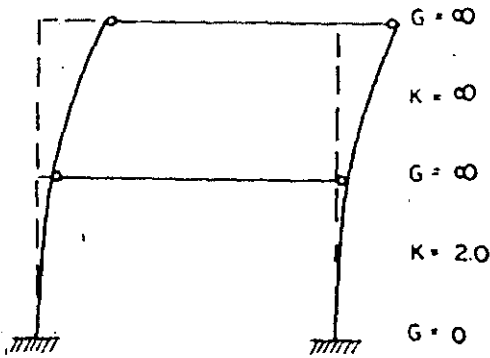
Marco no contraventado, con vigas articuladas a las columnas
